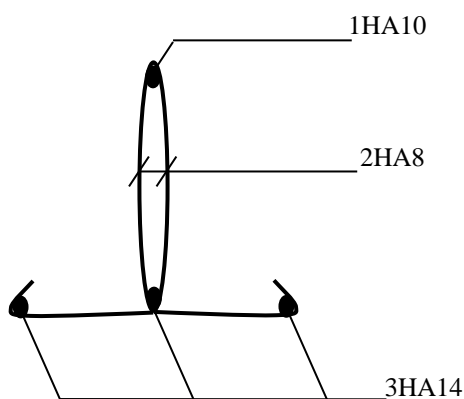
Plan de ferrailage de la poutrelle en travée
